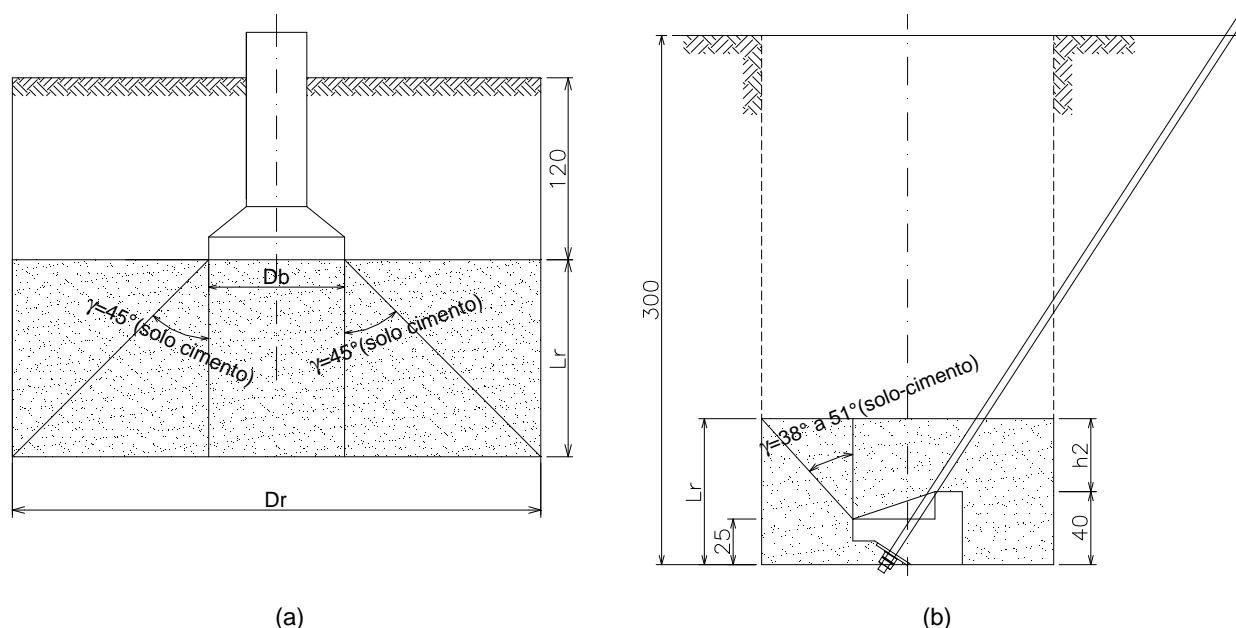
Comportamento de espraio de tensões a) Sapata típica pré-moldada com regeneração para mastro b) Bloco pré-moldados (vigas “L”) para as fundações dos estais
